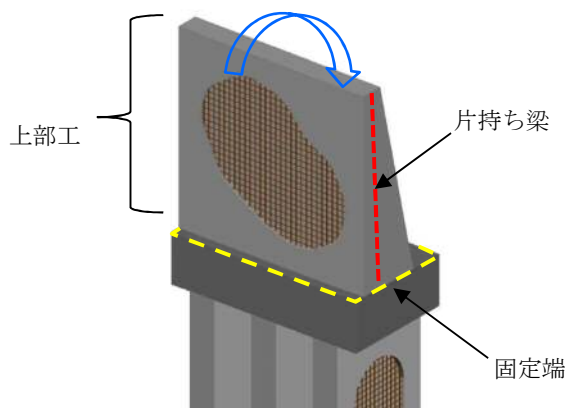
鉄筋コンクリート防潮壁の上部工[一般部]
